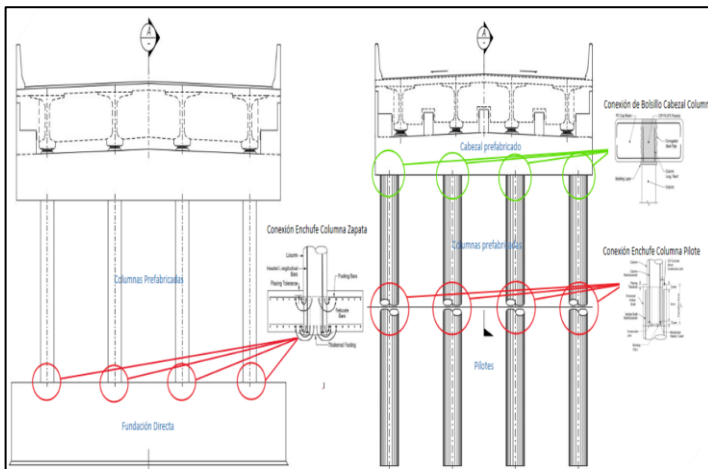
Elementos y conexiones a diseñar Estribo y Cepa. Fuente: *Planos del proyecto modificados*.
